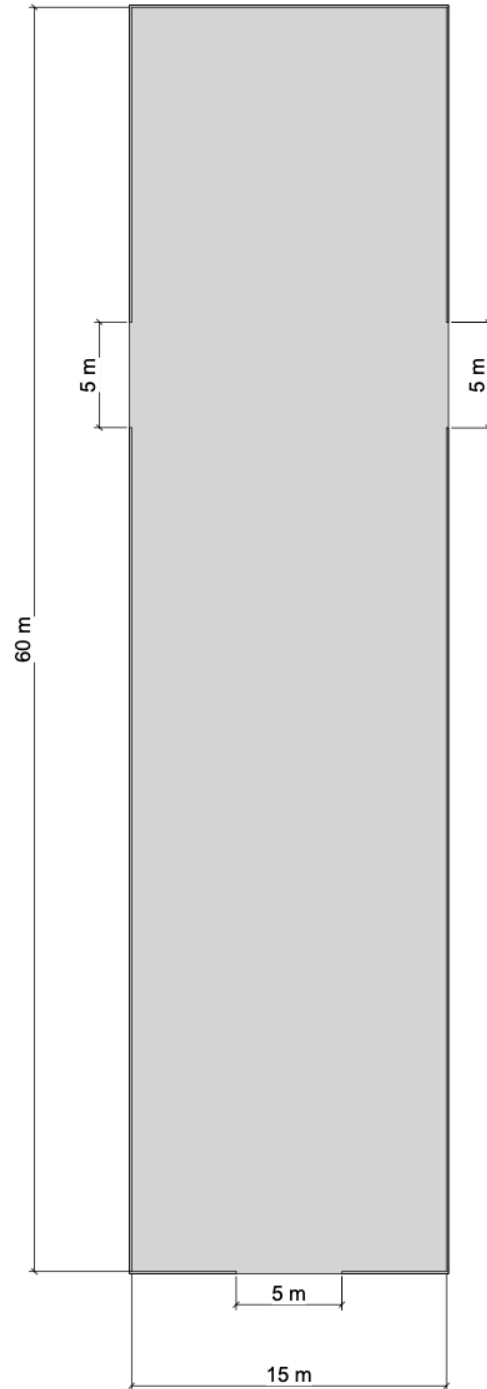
Vista superior de la planta baja de la solución volumétrica C. Fuente: Elaboración propia.
